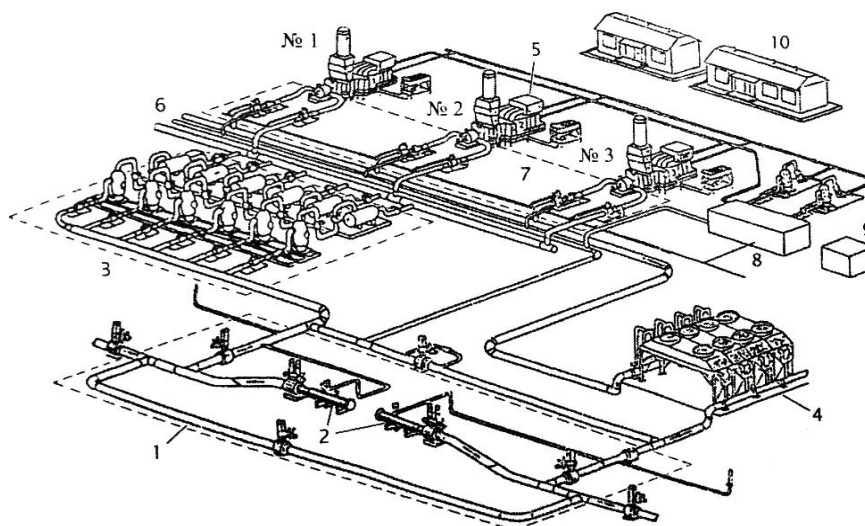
План компоновки оборудования компрессорной станции: 1 – байпас КС; 2 – камеры приема и запуска очистных устройств; 3 – установка очистки технологического газа; 4 – установка охлаждения технологического газа; 5 – газоперекачивающий агрегат; 6 – технологические трубопроводы обвязки КС; 7 – запорная арматура технологических трубопроводов; 8 – блок подготовки пускового, топливного и импульсного газа; 9 – оборудование электрохимической защиты трубопроводов обвязки КС; 10 – главный щит управления
